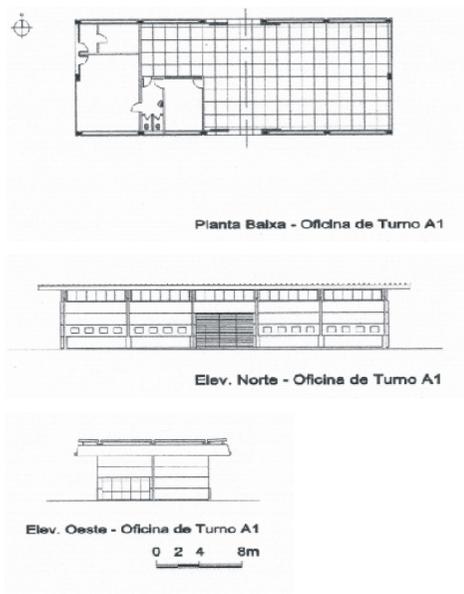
Refinaria Alberto Pasqualini, planta baixa e elevações, oficinas, 1962.
